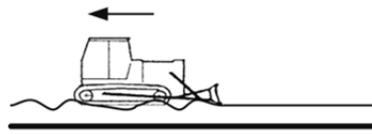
Lagenweiser Bodeneinbau mit Planierraupe [5]
